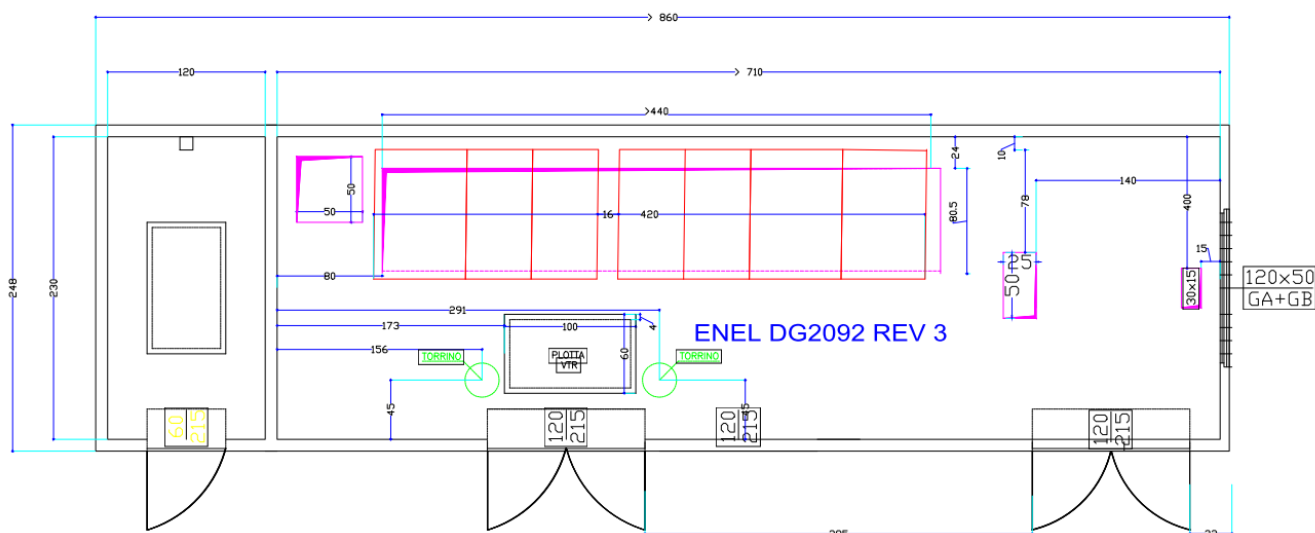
planimetria cabina di consegna di e-Distribuzione
